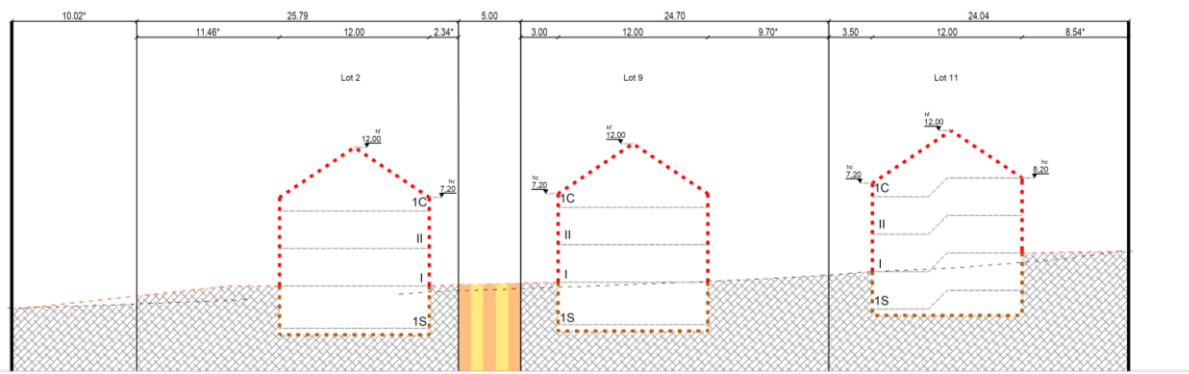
Vue en coupe des gabarits constructibles des lots 2, 9 et 11 (Source : BEST)
